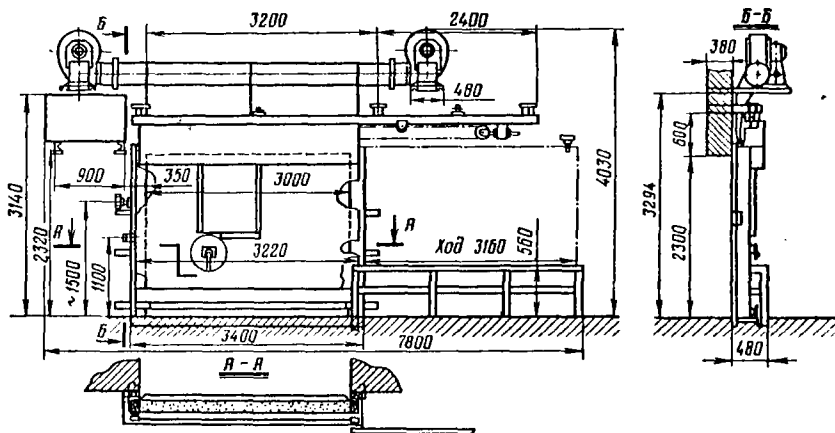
Дверь грузовая откатная с воздушными завесами.
